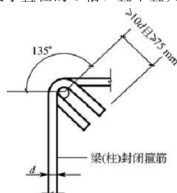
非焊接封闭箍筋的抗震构造
